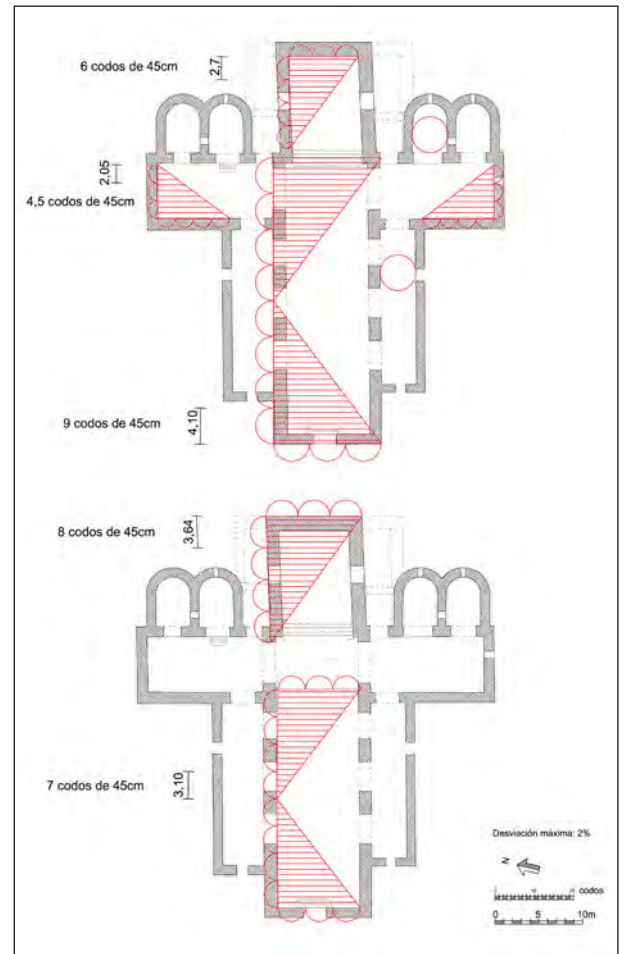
Planta de la fase del siglo X. Modulación de los espacios (planimetría de la autora).
